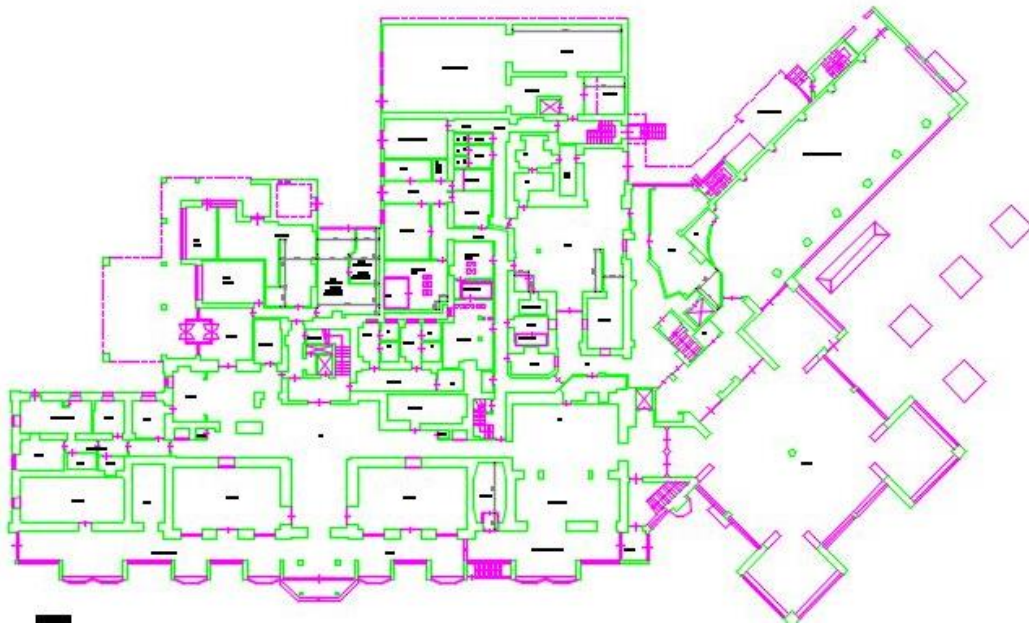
Planimetria Golf Hotel piano terra -stato attuale-
